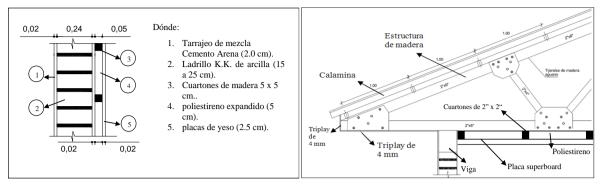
Cerramiento en muros y cubierta de aula modificada, I.E.S. Pacaje, 2016
